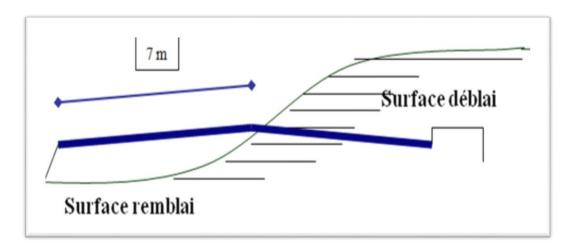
Les sections des profils en travers d'un tracé donné.
